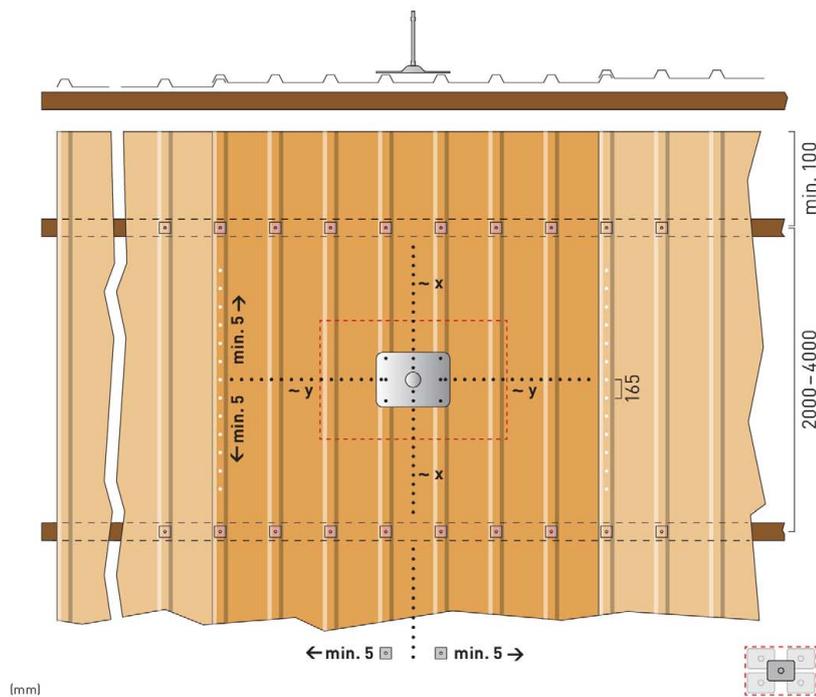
Anschlag-einrichtung PT+ auf Stahltrapezprofil in Negativlage (Dachdeckung)
